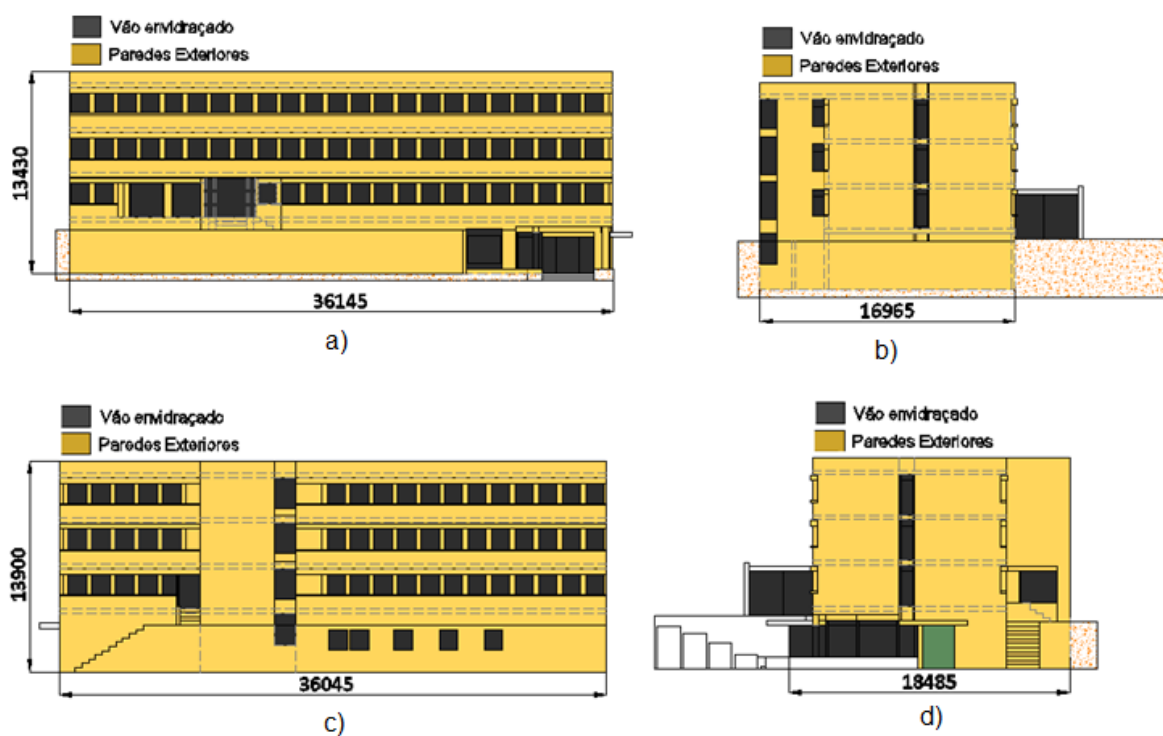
Identificação de envidraçados e paredes exteriores: a) Fachada Este; b) Fachada Sul; c) Fachada Oeste; d) Fachada Norte
